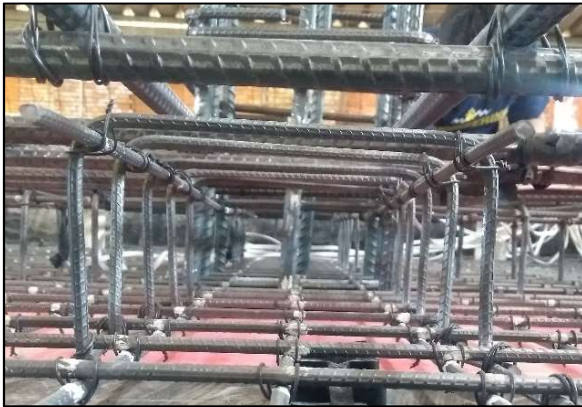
Detalhe do estribo “caranguejo” na laje CCA.
